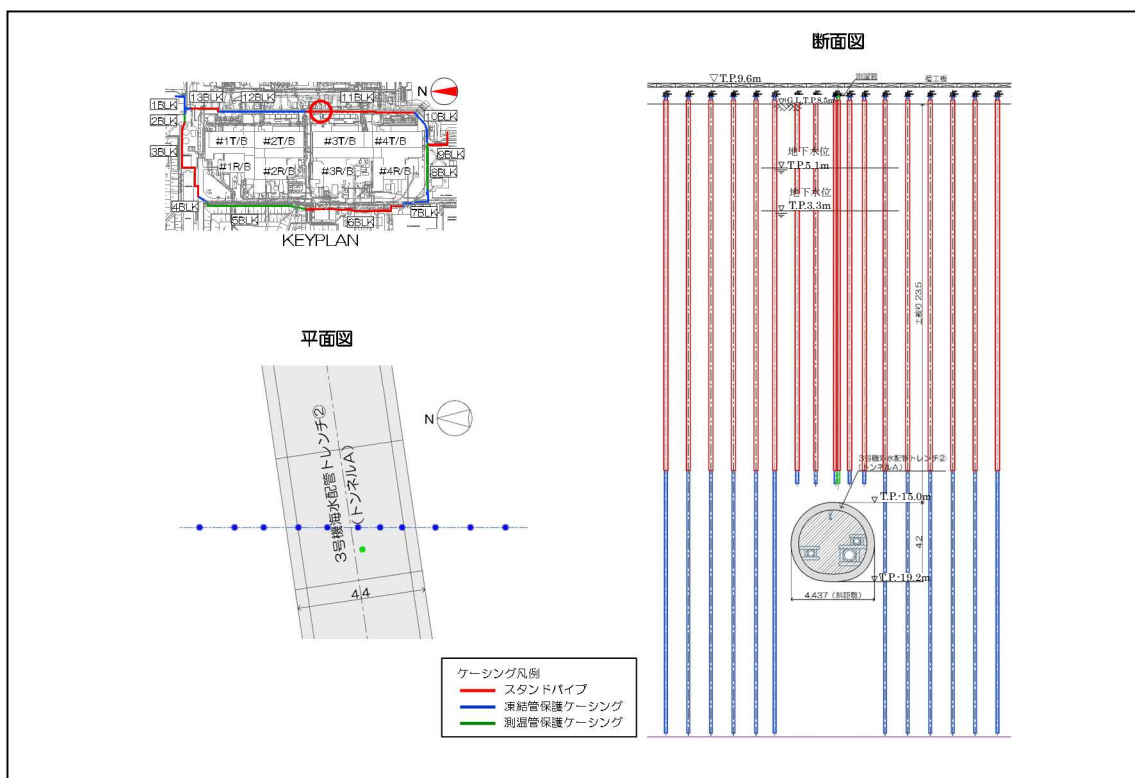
3号機海水配管トレンチトンネルA部 施工平面図・断面図
